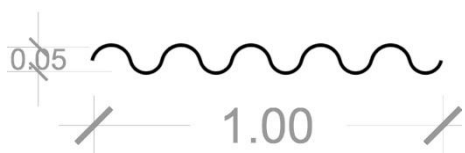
dimensiones de lámina. Fuente: L. Rodríguez
